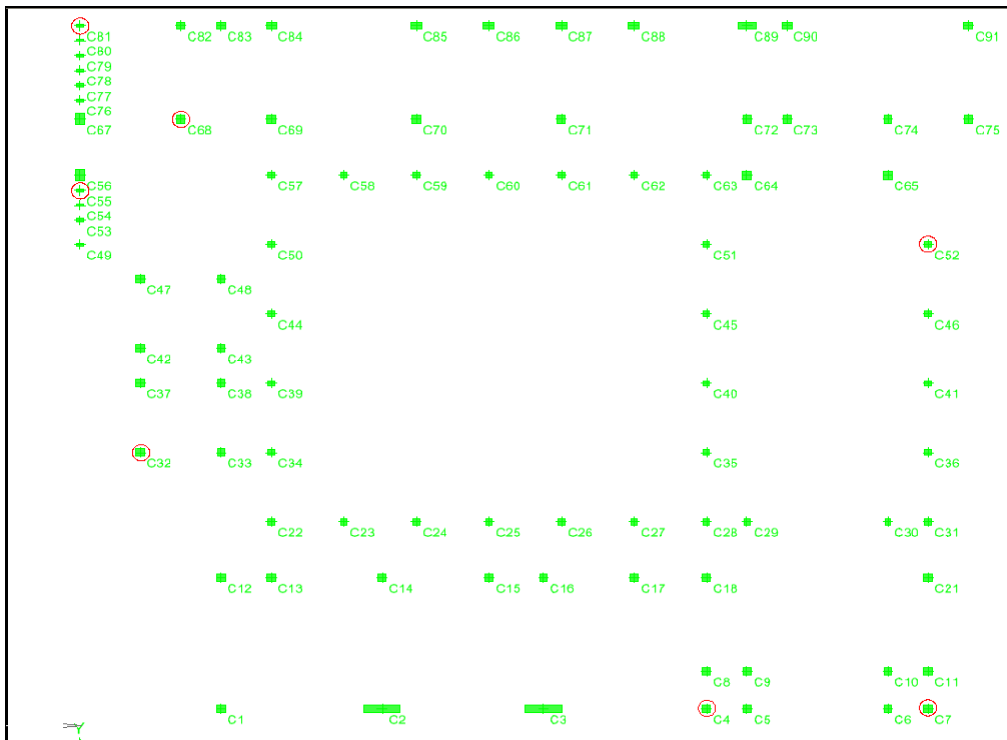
Esquema que indica cuales son las columnas que fallan por corte..
